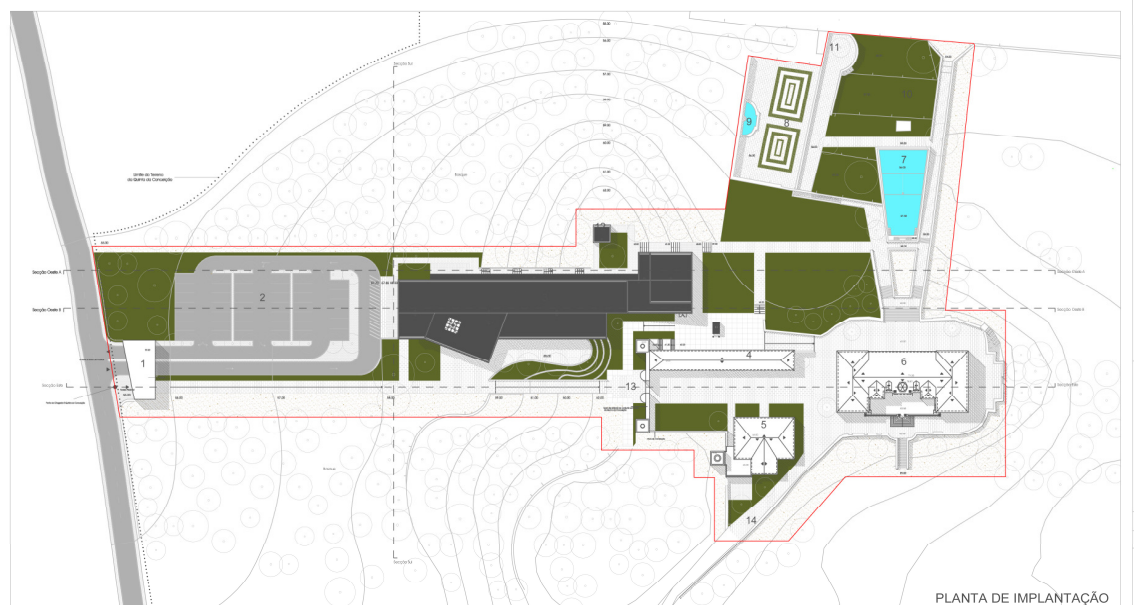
Planta de implantação da Proposta para a Quinta da Conceição.
